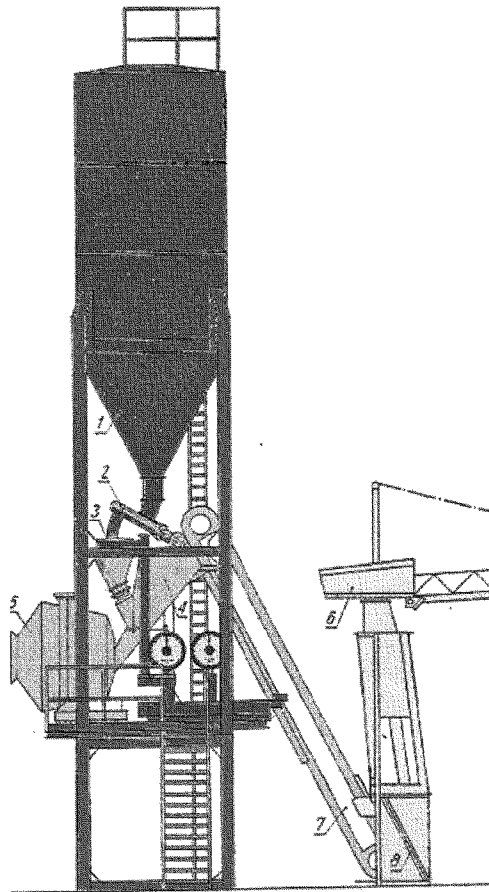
Betonownia bezzasobnikowa przestawna: 1 – zasobnik cementu, 2 – podajnik wibracyjny, 3 – automatyczny dozownik, 4 – betoniarka, 5 – konstrukcja wsporcza betoniarki, 6 – prowadnice, 7 – podstawa zasobnika, 8 – przenośnik taśmowy, 9 – łopata mechaniczna, 10 – przegroda dwuzasiekowa
